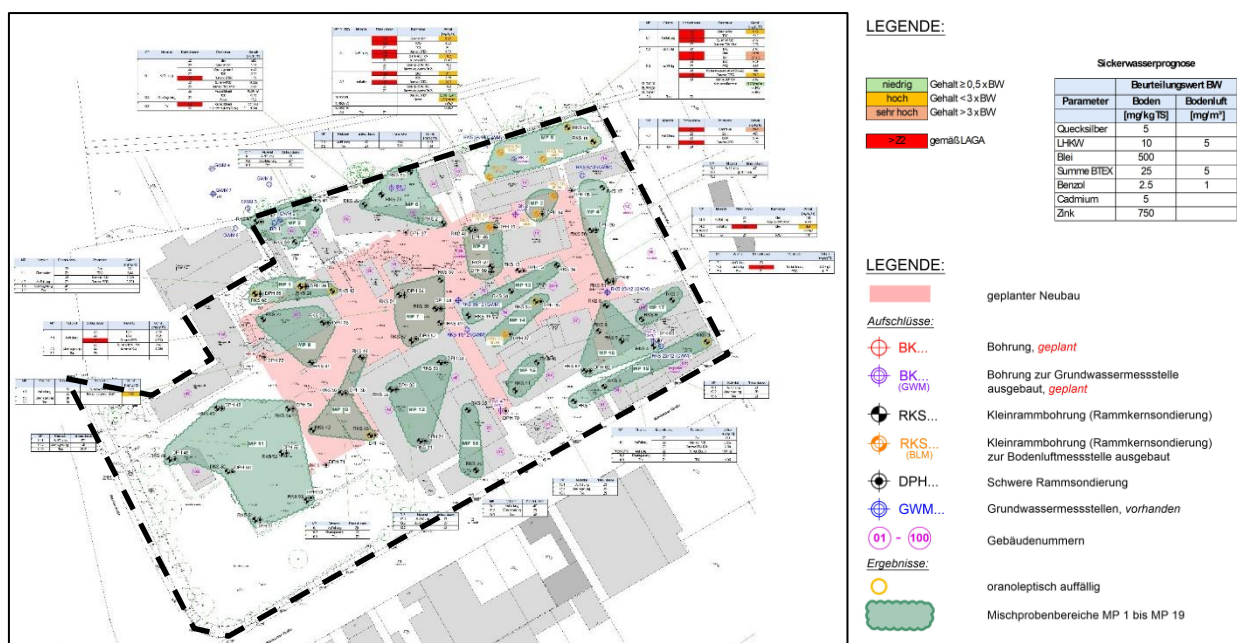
Ausschnitt Lageplan mit Untersuchungsbereichen Quelle: Bericht zu Versickerung und Kontamination BfM 2025
